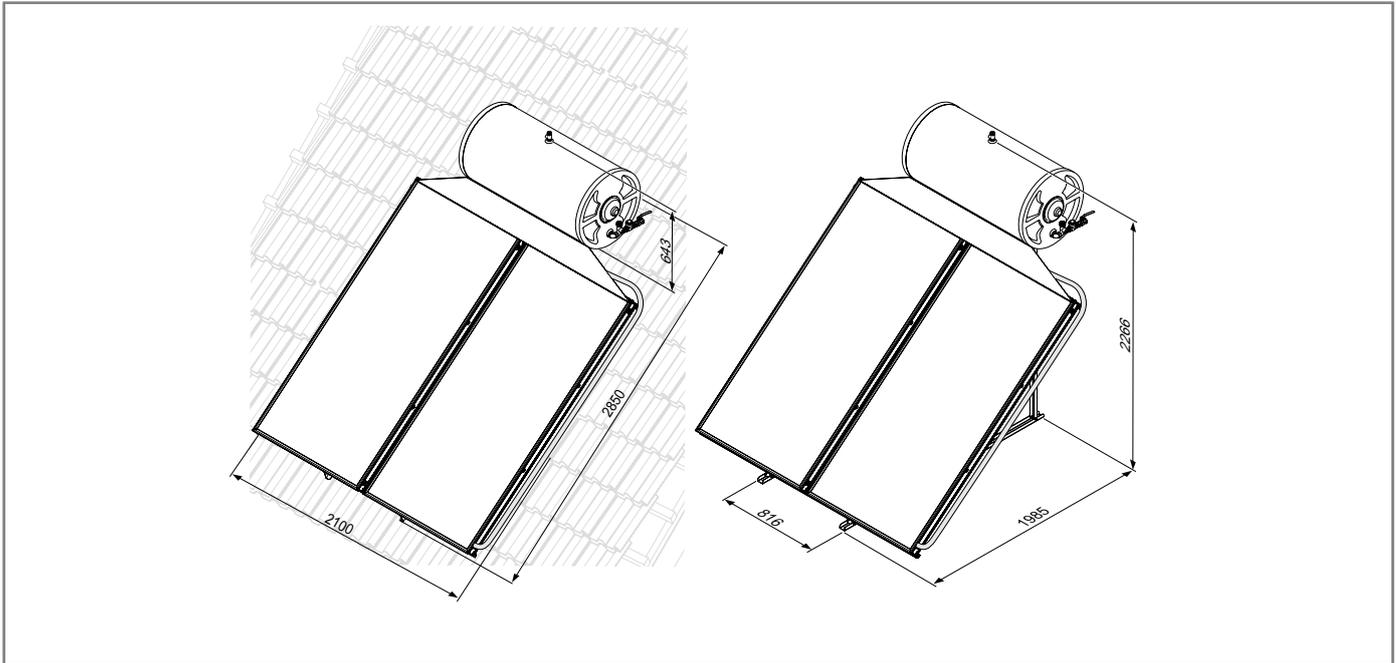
2-200 su tetto inclinato, 2-200 su tetto piano
